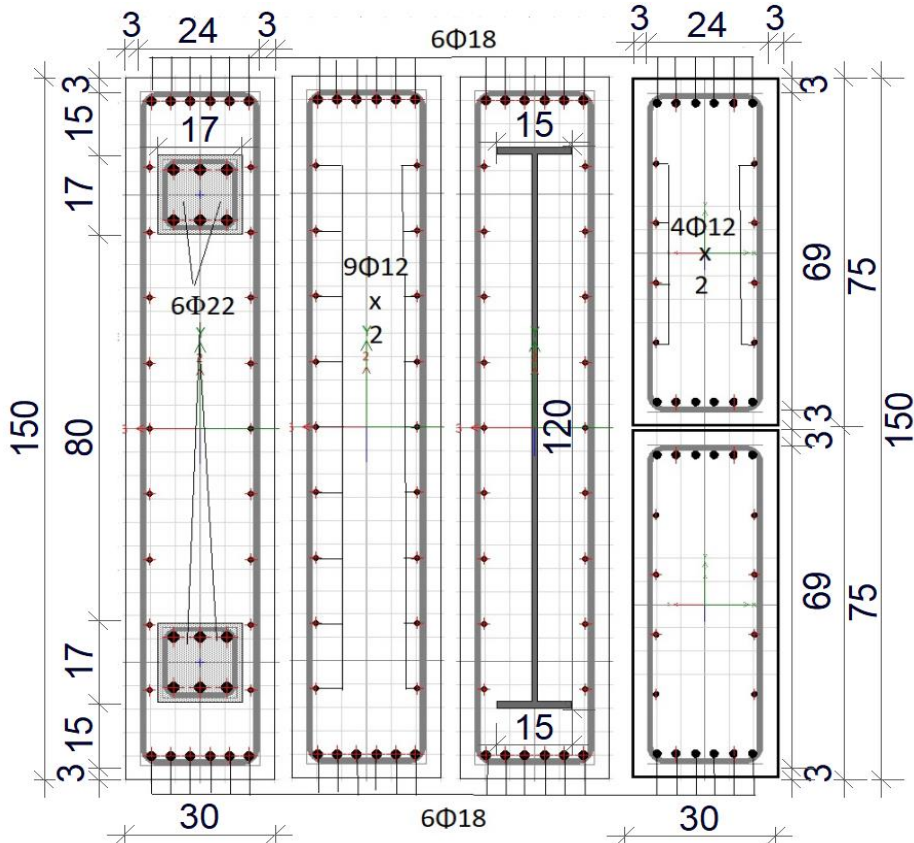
Ba ğ Kirişlerinde Çift Kiriş Modeli (Choi vd., 2018) (Double Beam Model on Coupling Beams)
